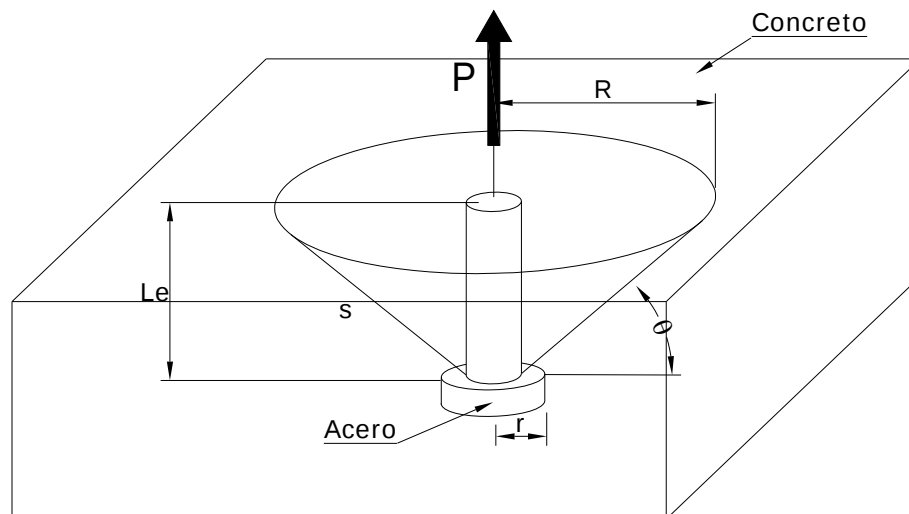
Geometría de fisuración del cono de corte.
